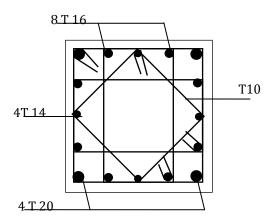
Schéma de ferraillage des poteaux 2éme, 3éme étage.
